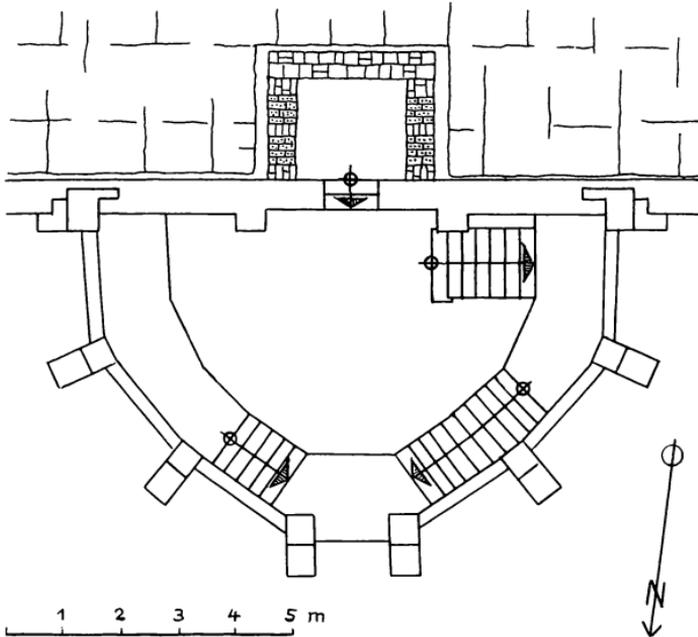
Grundriß der Dunsthöhle mit dem Vorkeller (dieser vereinfacht nach Bauzeichnung des Staatl. Hochbauamtes Hameln, Außenstelle Bad Pyrmont). Umfassungsmauer der Dunsthöhle mit Sitznischen (punktiert).
